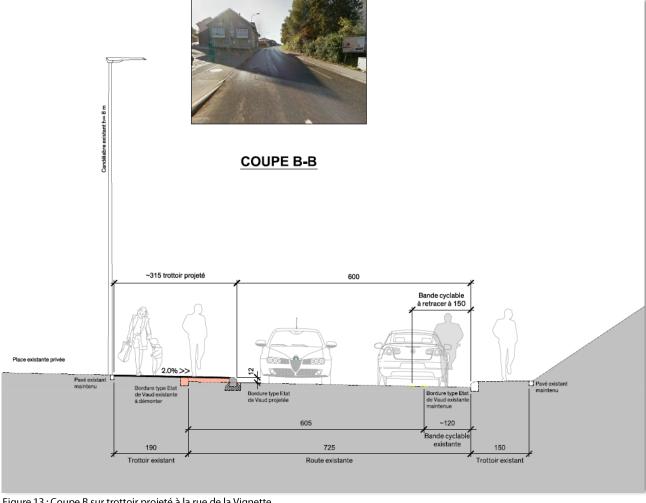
Coupe B sur trottoir projeté à la rue de la Vignette
